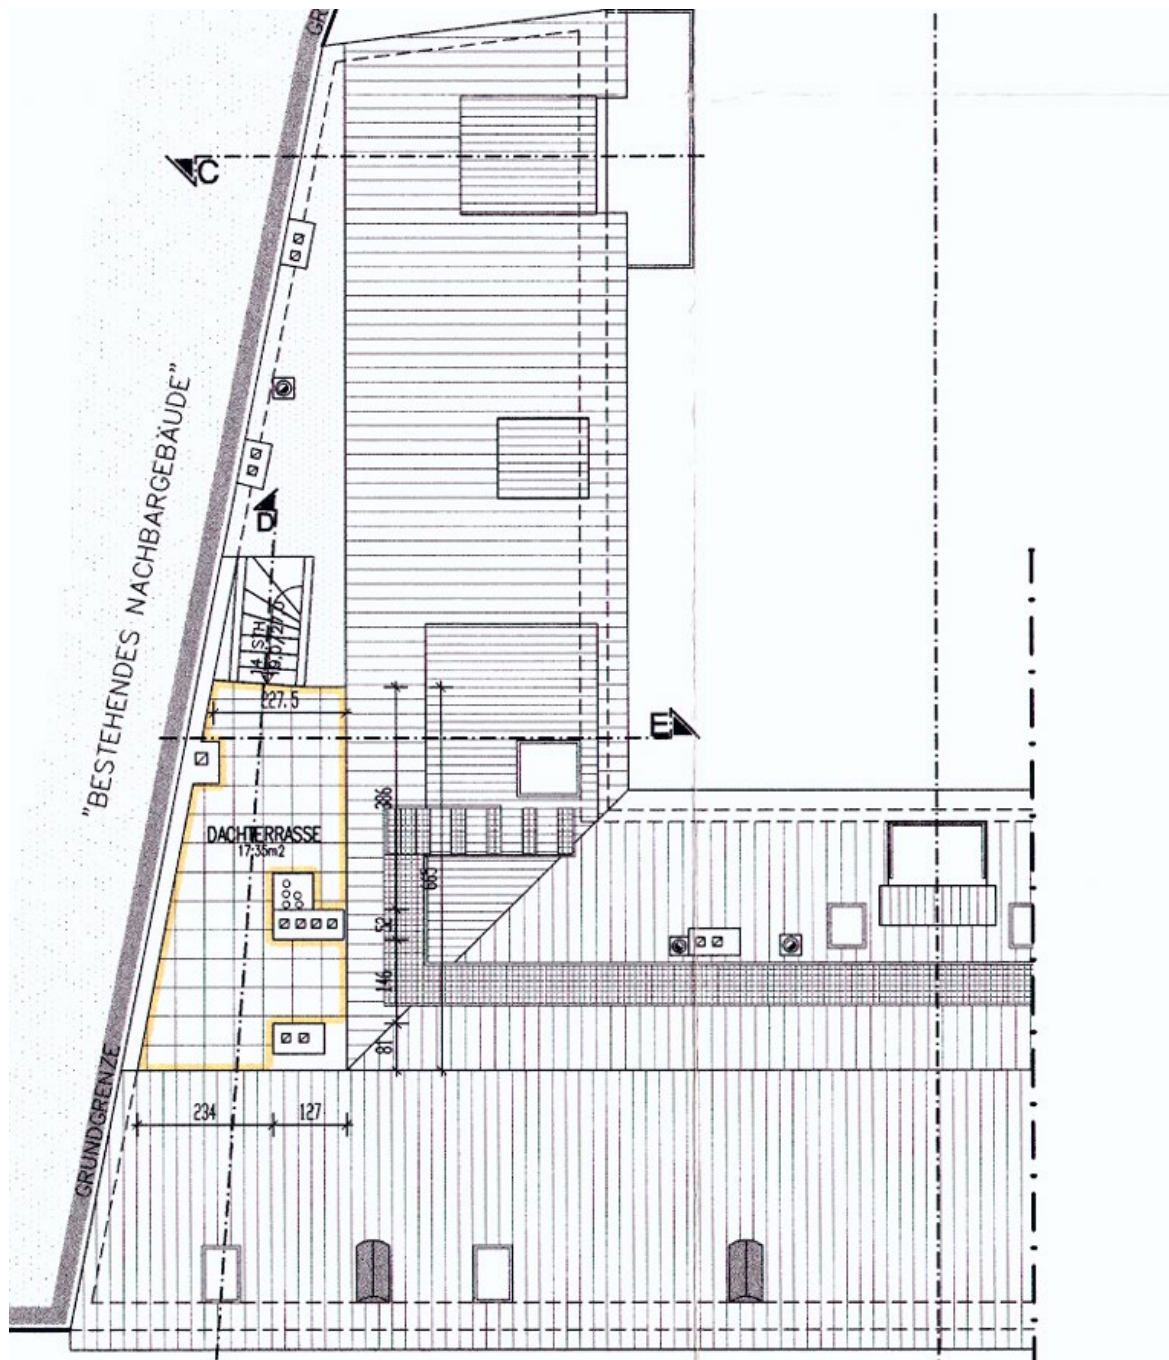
Dachterrasse - Wohnung Top D 3 (Einreichplan 03.12.2002)
